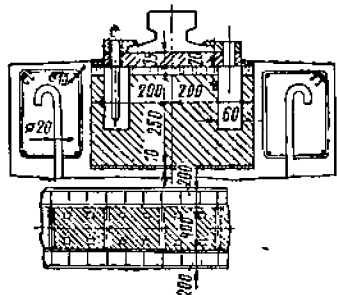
Крепление подкранового пути к фундаментной балке винтами
